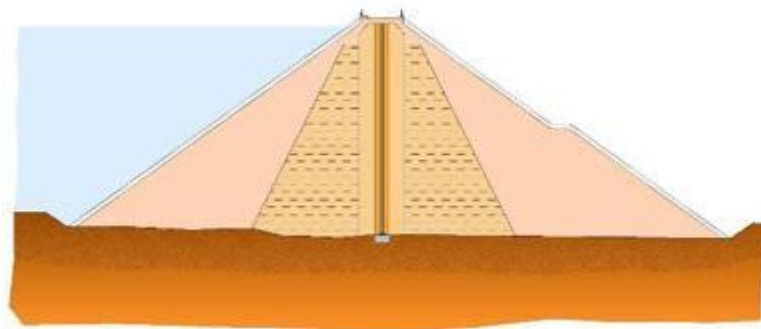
Secção transversal da barragem de Gouvães, no rio Torno e ainda em construção (Portugal)
